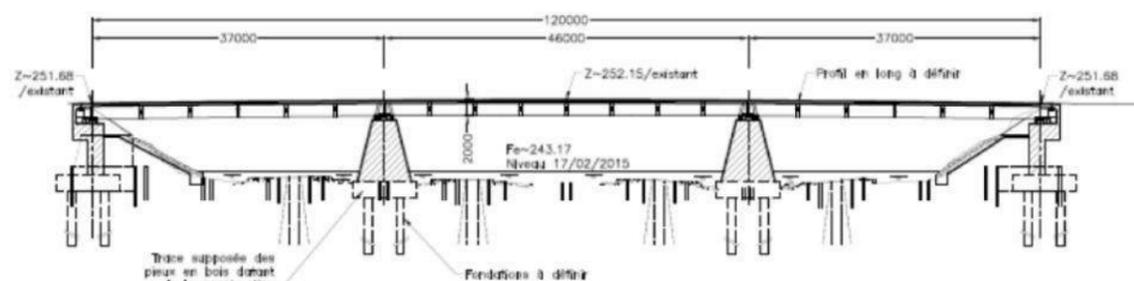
Coupe de l'ouvrage mixte acier/béton à hauteur constante à trois travées
